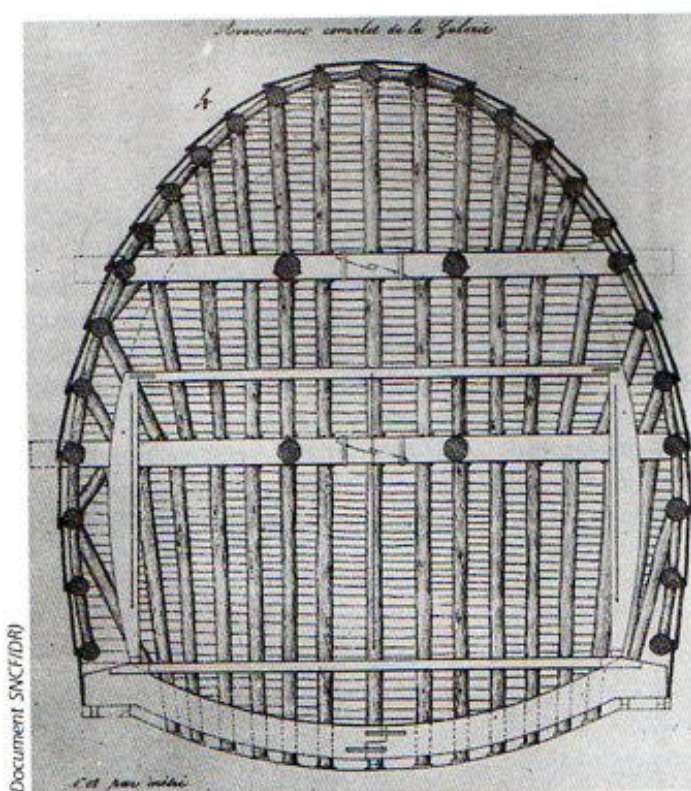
Blindage du front de taille, Tunnel de La Nerthe
